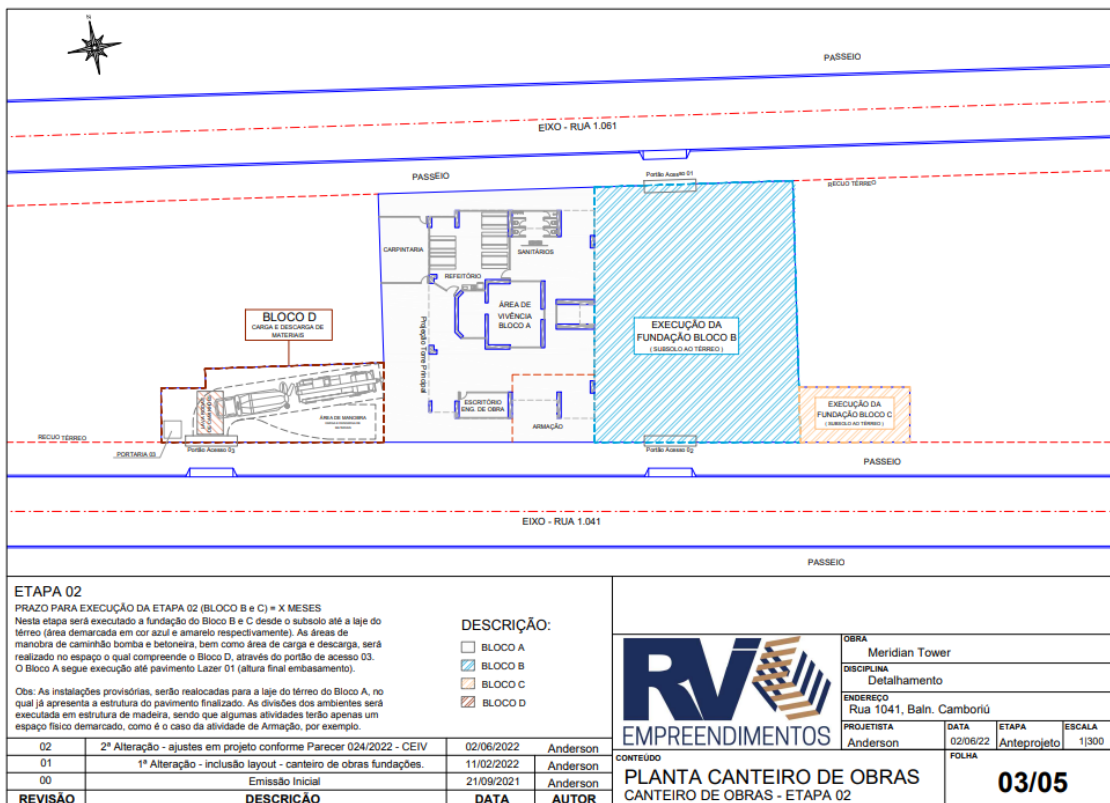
Projeto do canteiro de obras. Prancha 03/05
